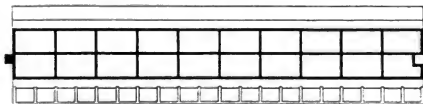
Kaimauerfundierung auf Betoneisentrog (Grundriß).
